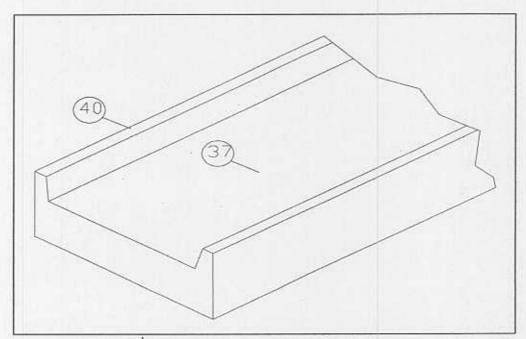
สะพานชนิด Deck Plate Girder
